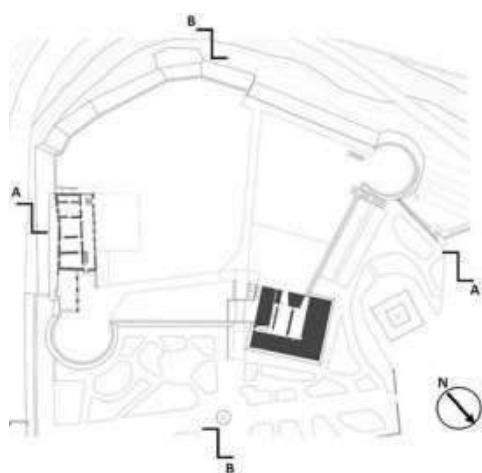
D. Falcioni, M. Mencarelli, Planimetria della Rocca di Camerino nello stato precedente al terremoto del 2016, 2021
